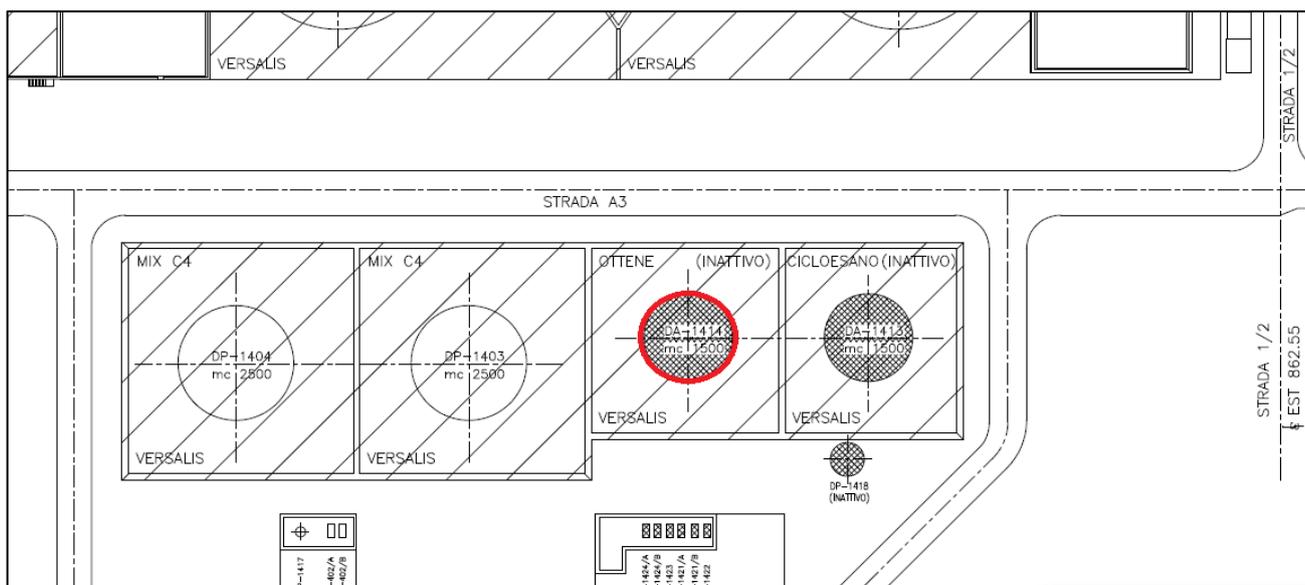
Dettaglio posizionamento planimetrico serbatoio DA1414 in SG11
